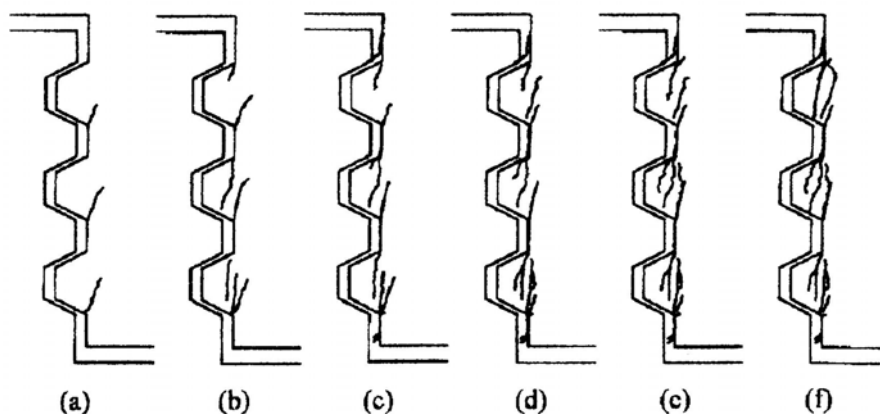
Secuencia de la fisuración para junta con epoxy y llaves múltiples
